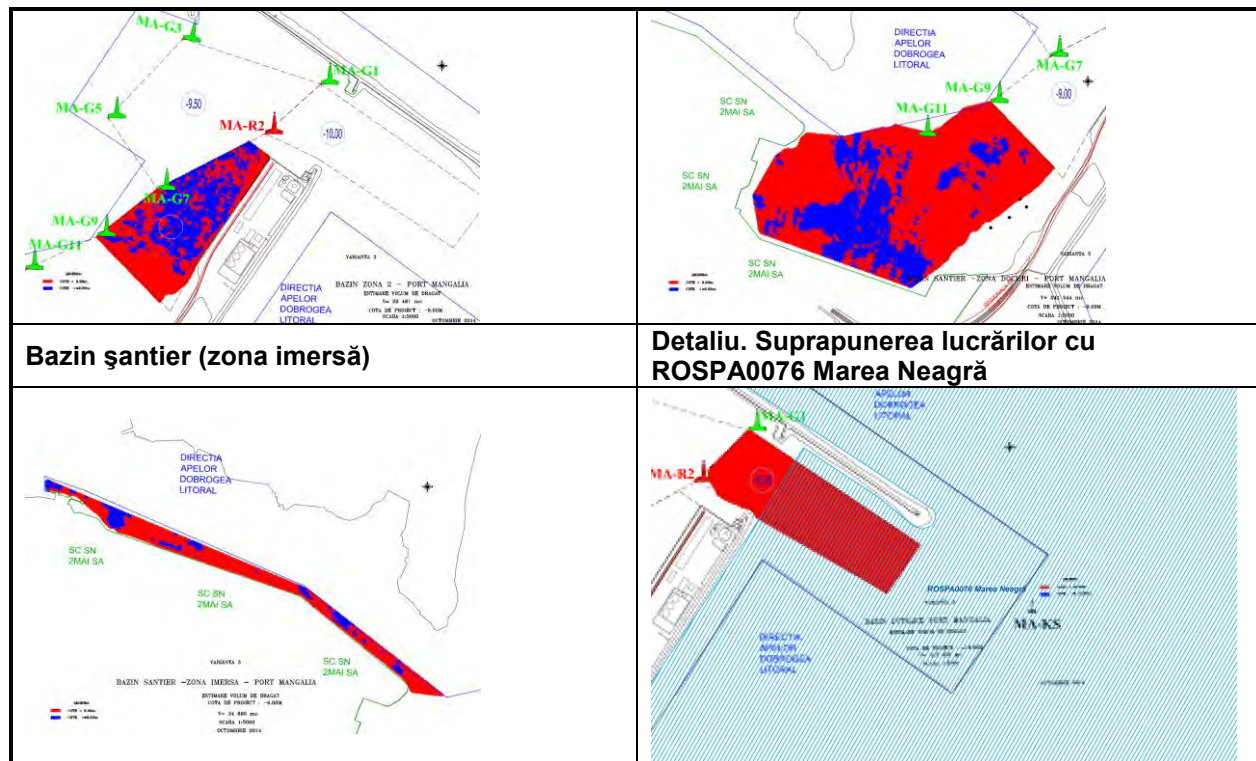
Plan de dragaj portul Mangalia.
